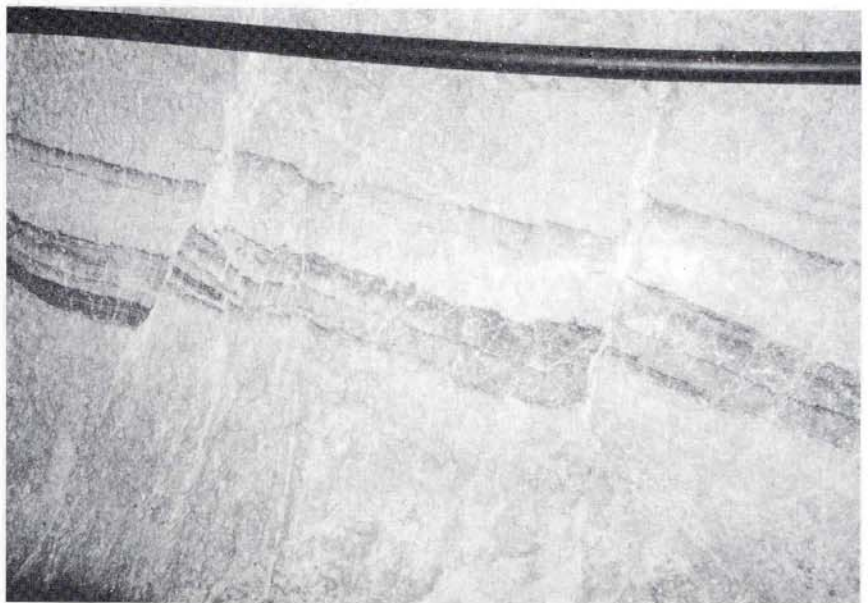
Foro Pilota Galleria FS Zuc del Bor (1986) - Zona con applicazione sistematica spritz-beton.
